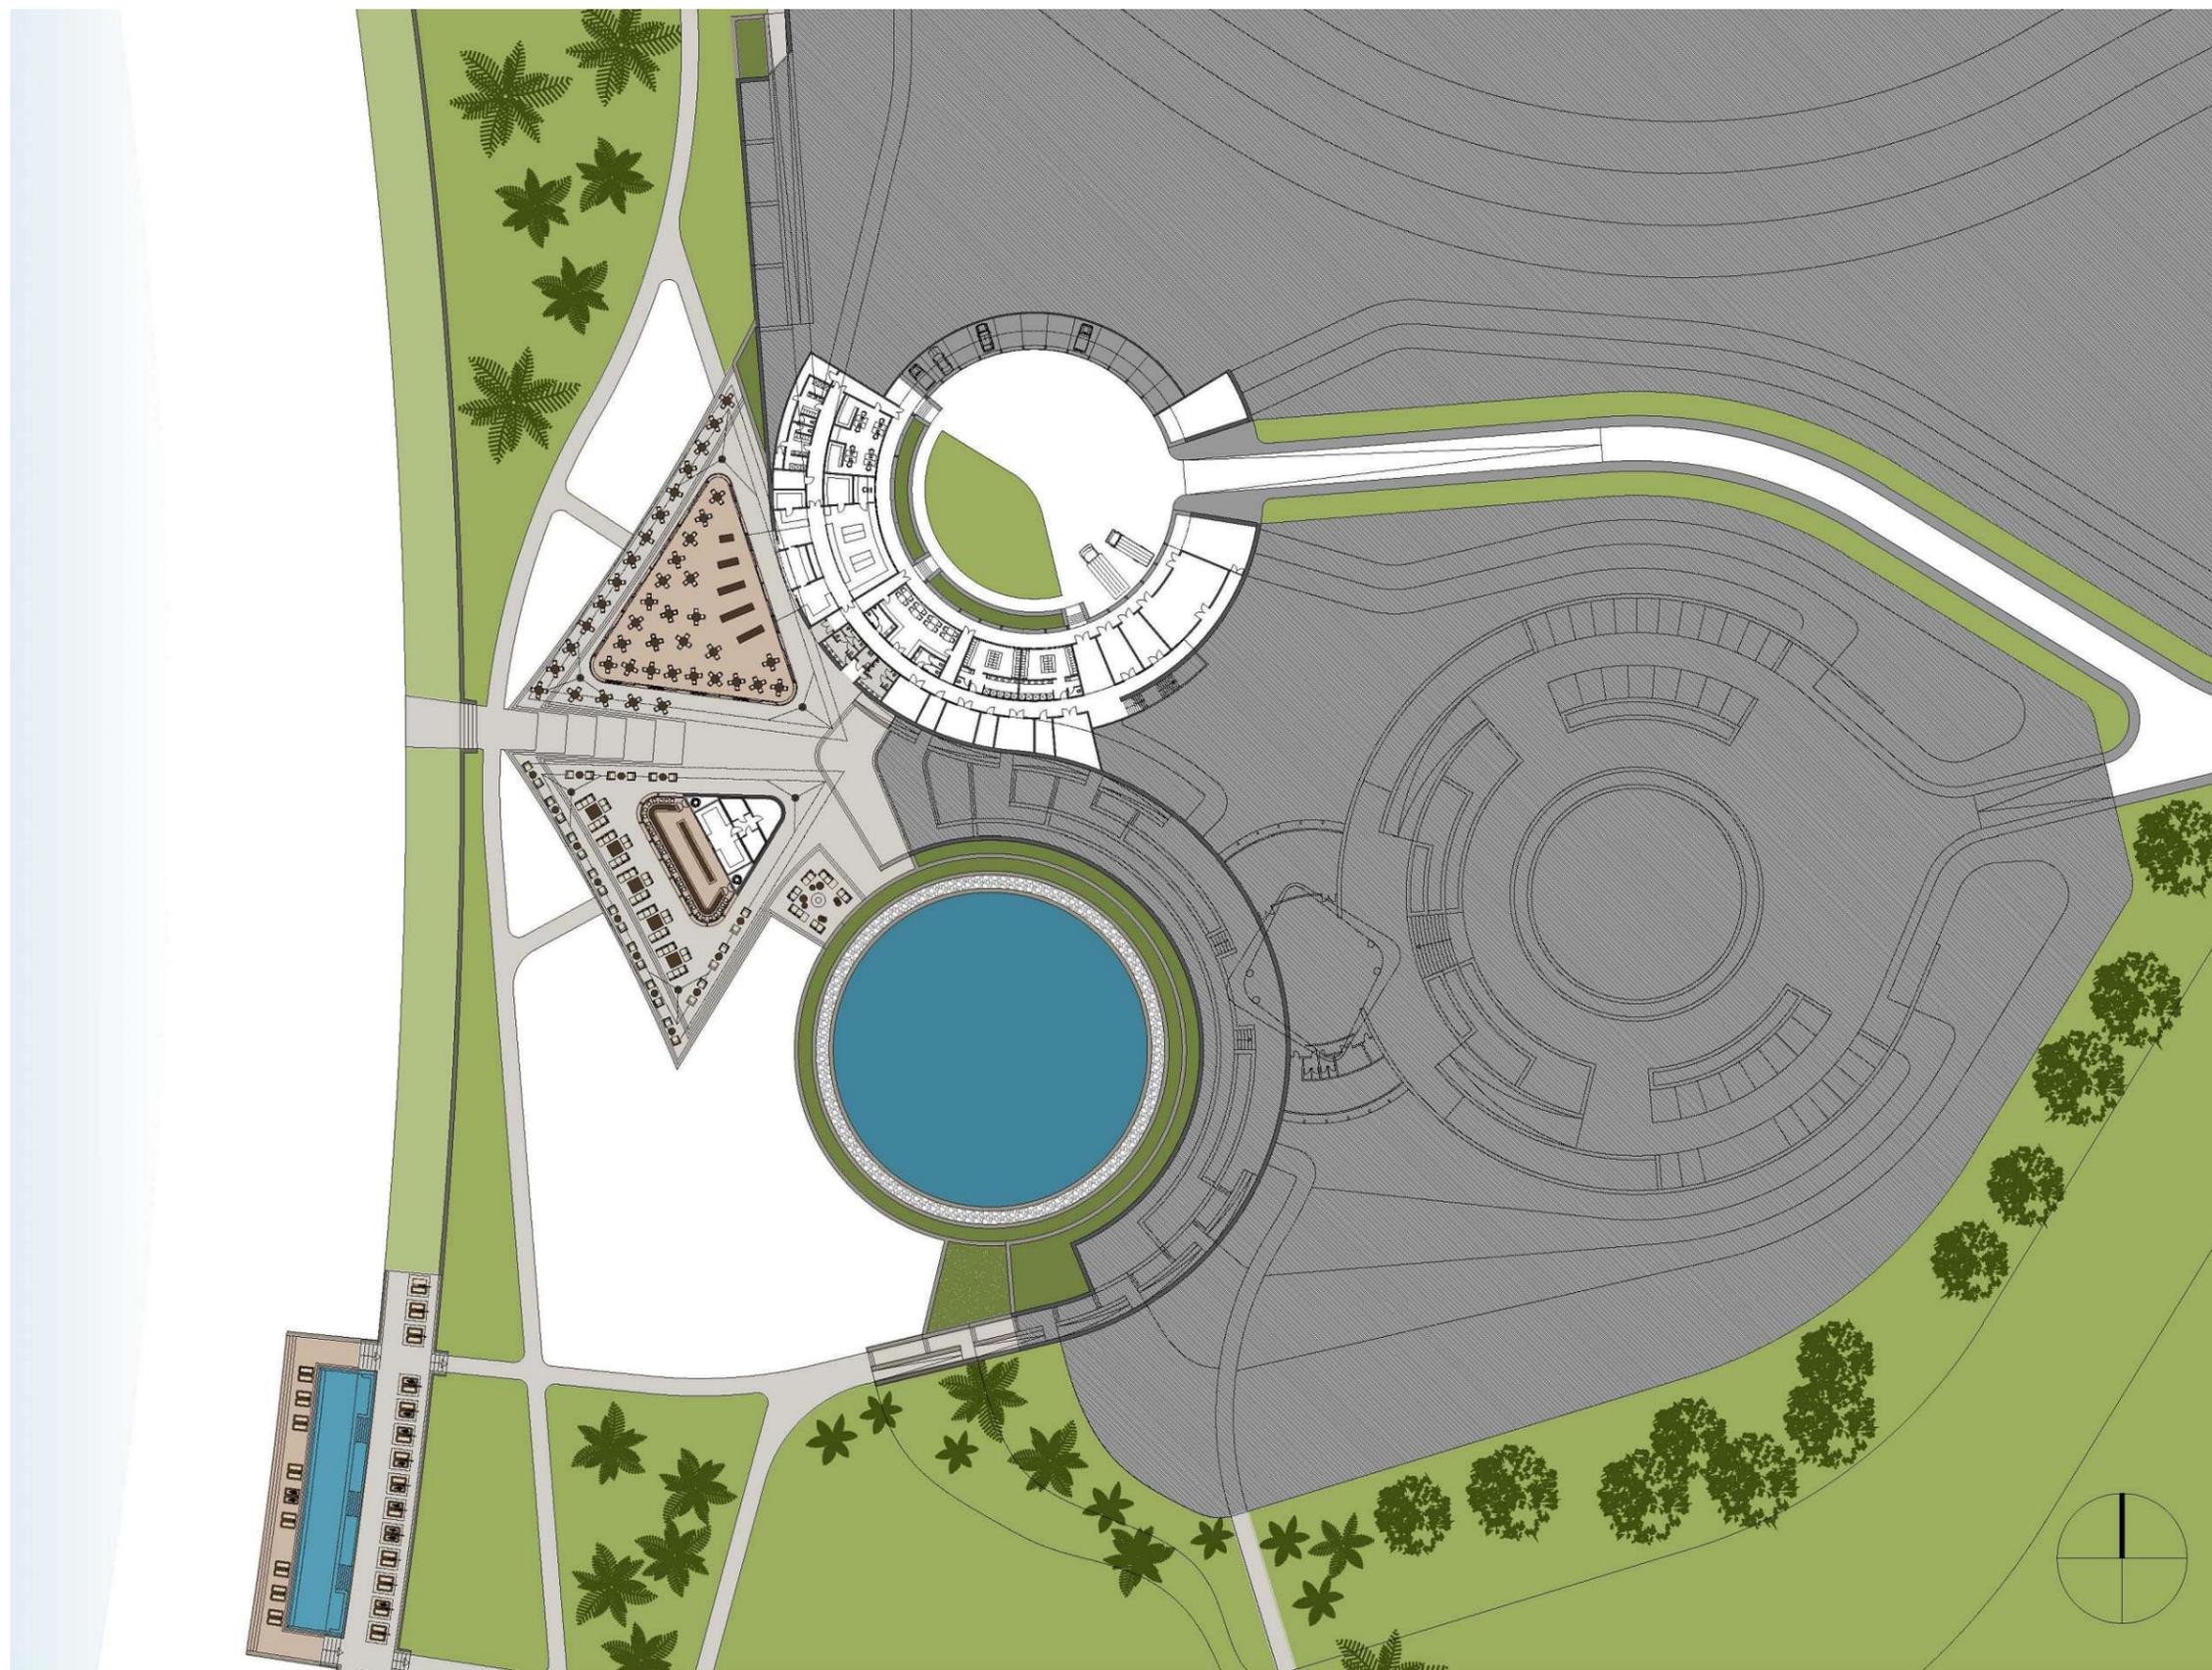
Grundriss Hauptgebäude Strandniveau
